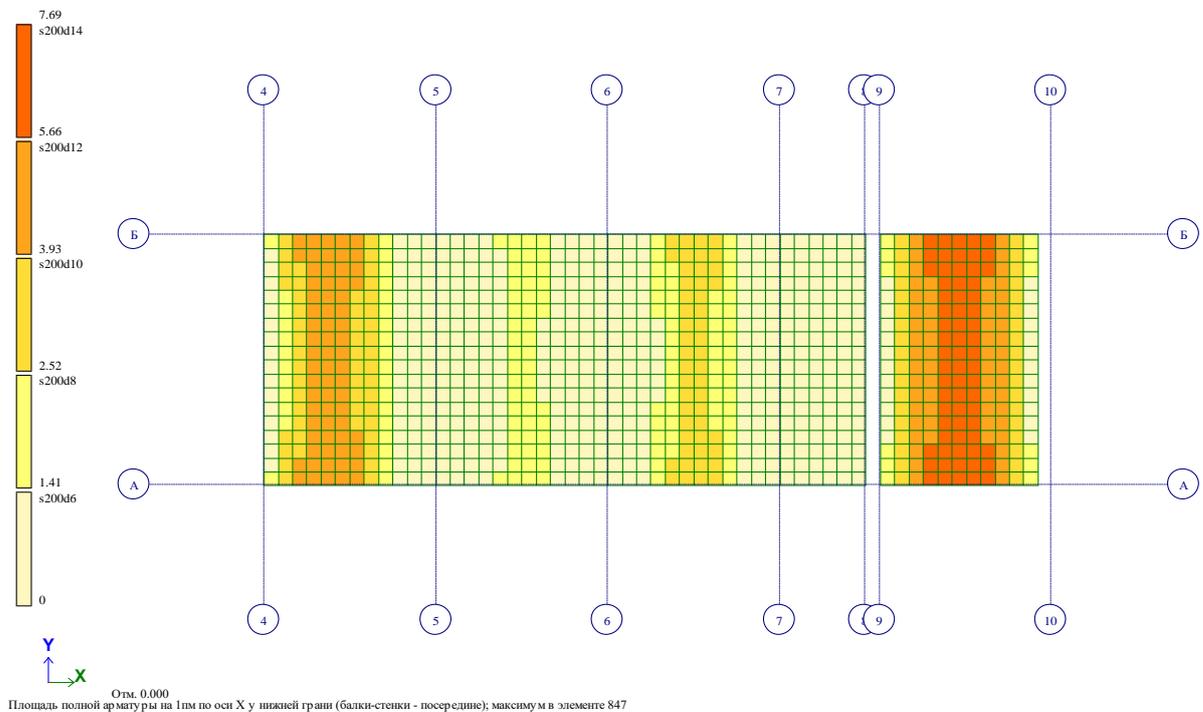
Требуемая площадь нижнего армирования по оси X
